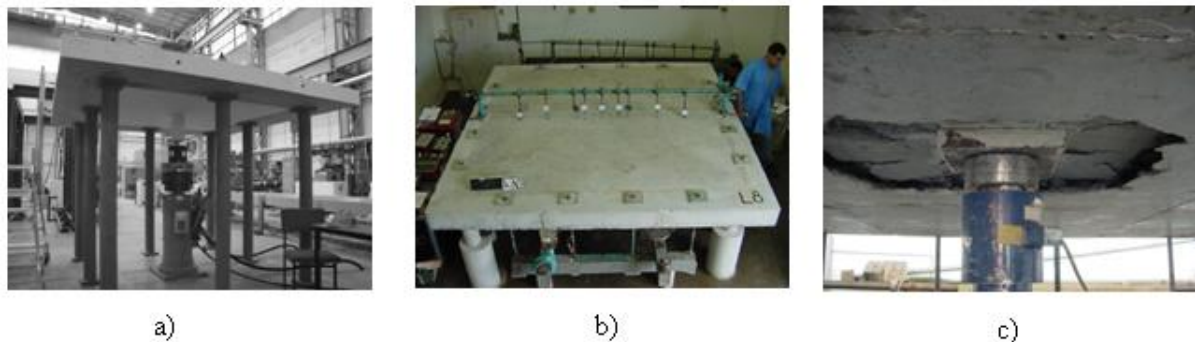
Ensaios em lajes: a) Laje apoiada em pilares (Kützing, 2000); b) Laje apoiada em elementos de betão e atirantada; c) Aplicação da carga através de um macaco hidráulica (Trautwein, 2001)
